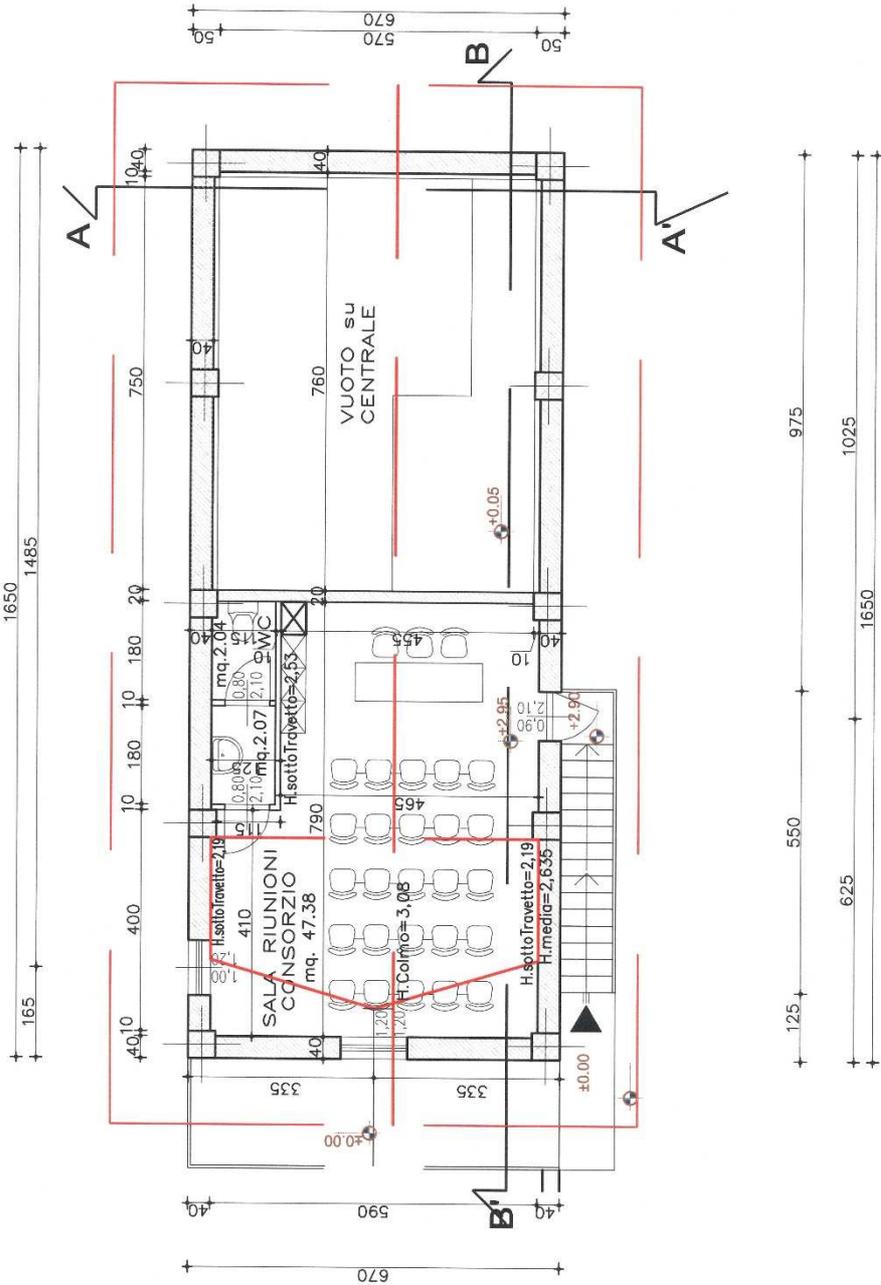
Pianta piano primo fabbricato centrale nel progetto autorizzato
